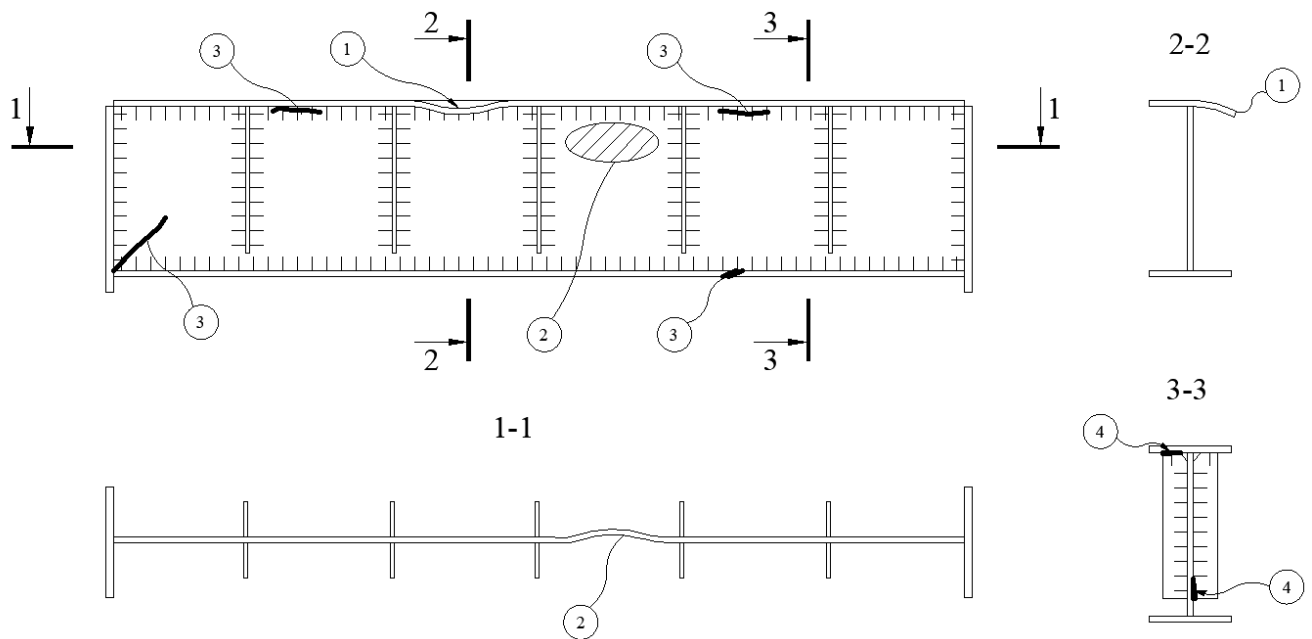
Схема дефектов и повреждений сварных подкрановых балок.
